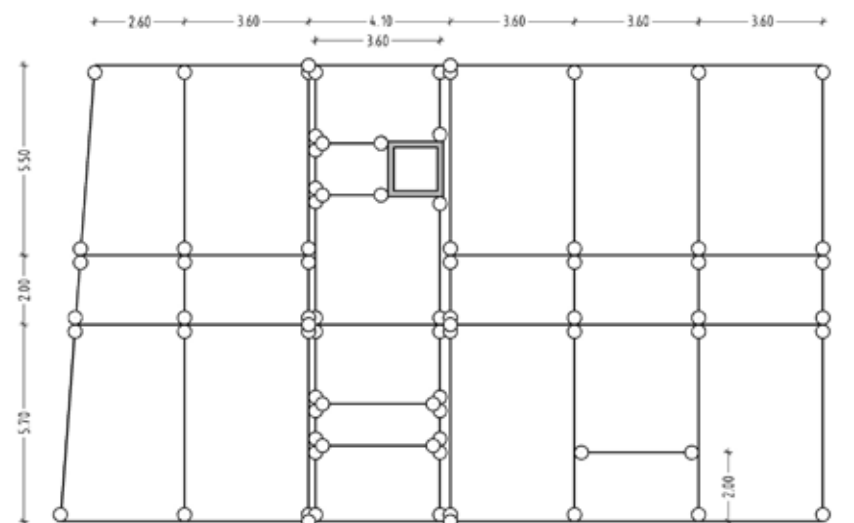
Grundriss Rahmen I [m]
